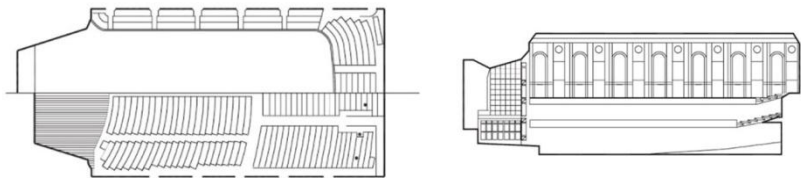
Planta Boston Music Hall; Imagen 2.33 Sección Boston Music Hall
